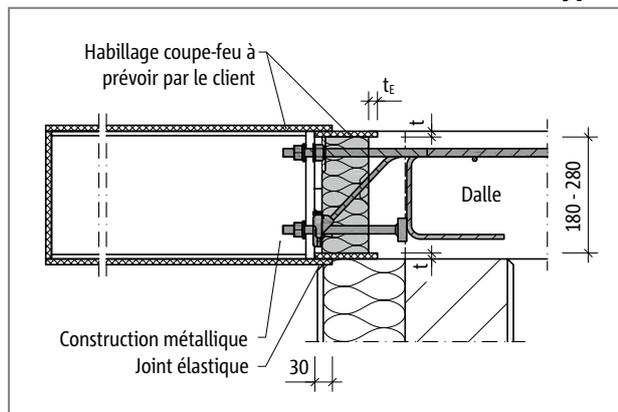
Schöck Isokorb® T type SK : Bardage de protection incendie sur site - T type SK et construction en acier ; coupe
